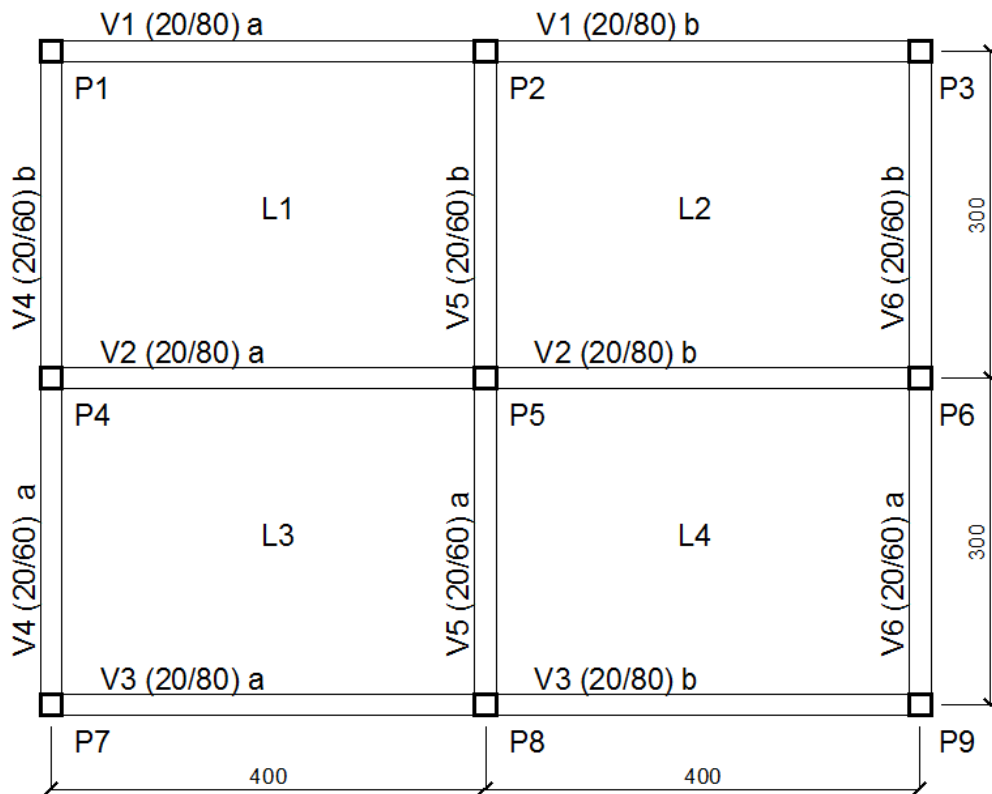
Exemplo 1 - Planta esquemática da forma do pavimento.
